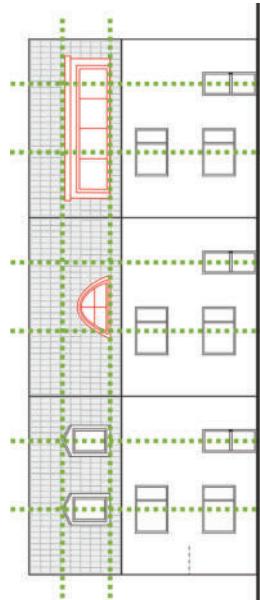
Achsen auf Dach und Fassade als Orientierungslinien für Dachgauben
